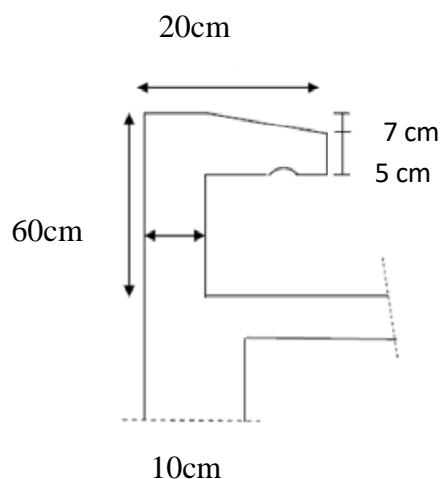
coupe en élévation de l'acrotère terrasse inaccessible.
